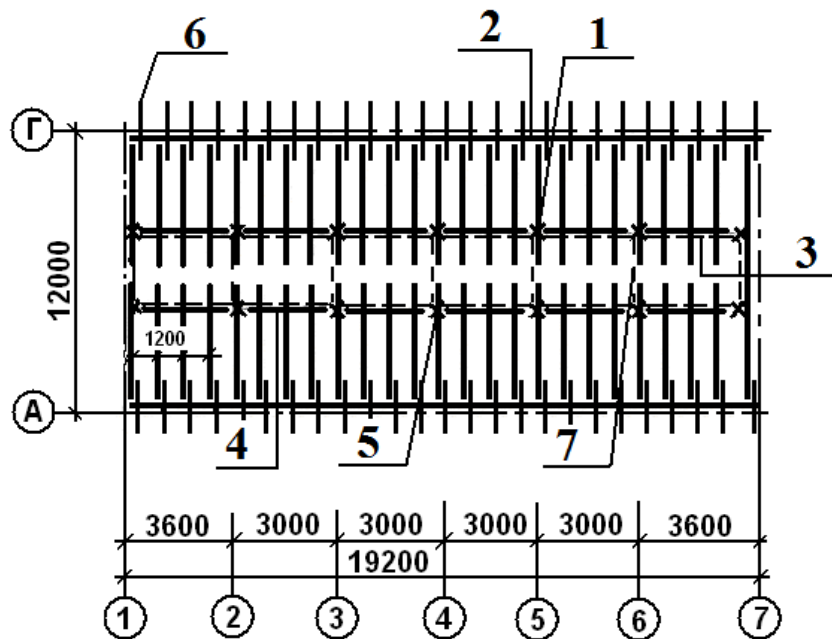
Пример оформления схемы расположения элементов стропил при поперечных несущих стенах
